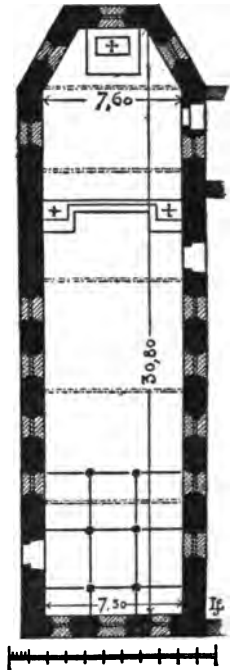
Marienhausen. Klosterkirche. Grundriss.
